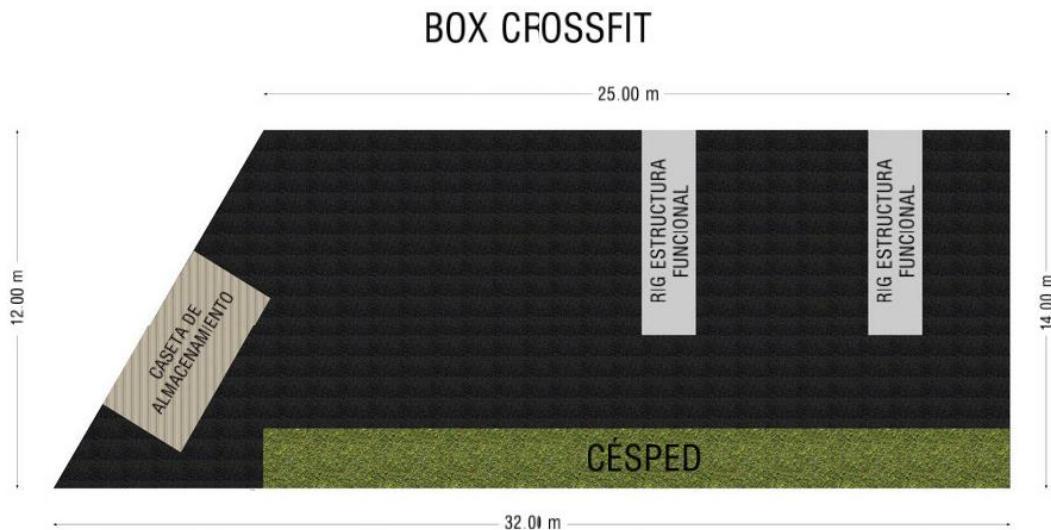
Elaboración propia. Plano de la zona propuesta
